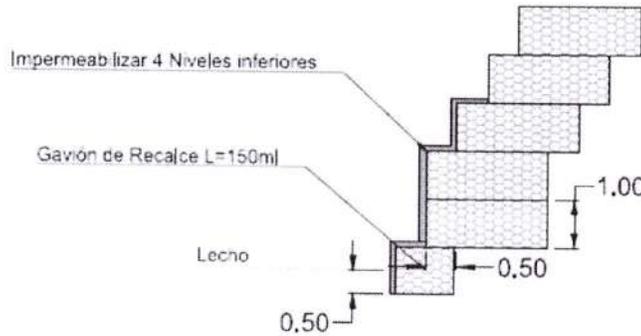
Planta de gaviones en el PK 290+994, Quebrada La Floresta
